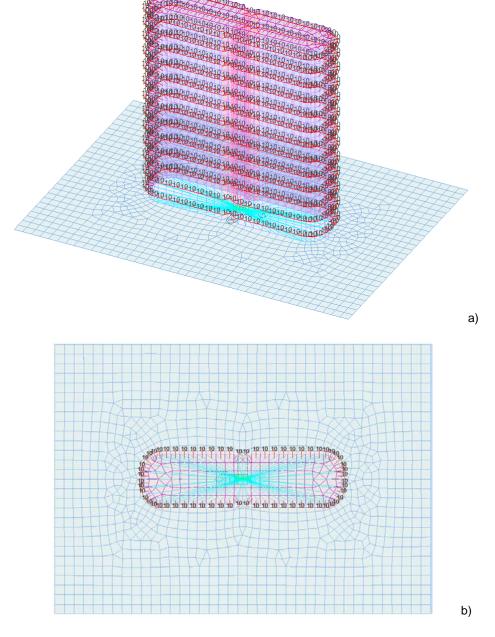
Applicazione del carico termico sul modello FEM – a) Vista 3D b) Vista in pianta
